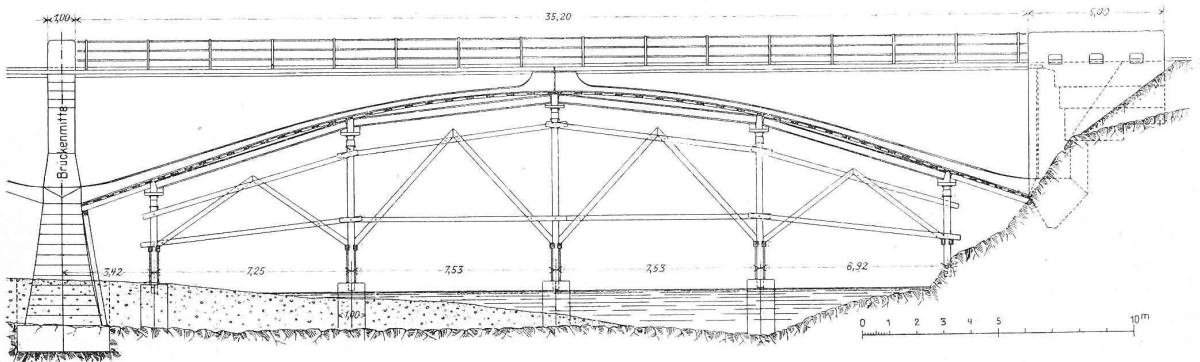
Ansicht einer Brückenöffnung mit dem Lehrgerüst. — Masstab 1:250.
